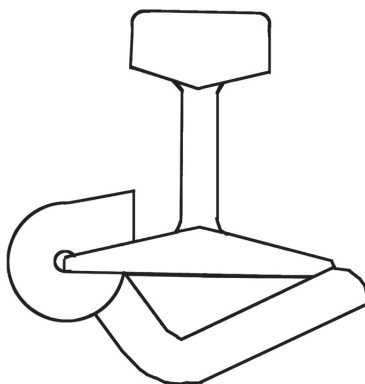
Tirefond sendo aplicado para fixar placa de apoio
